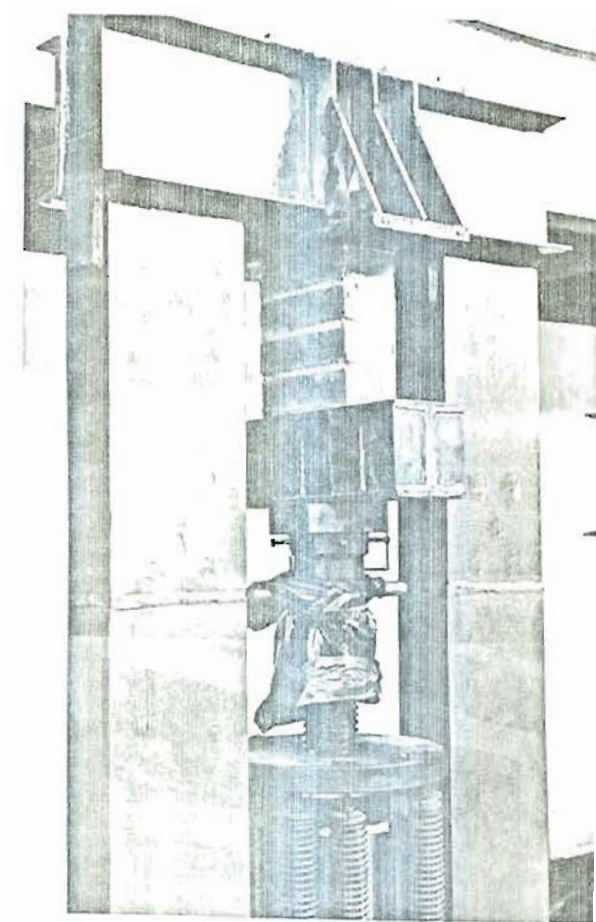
Ensaio de ruptura de um prisma tipo C.
